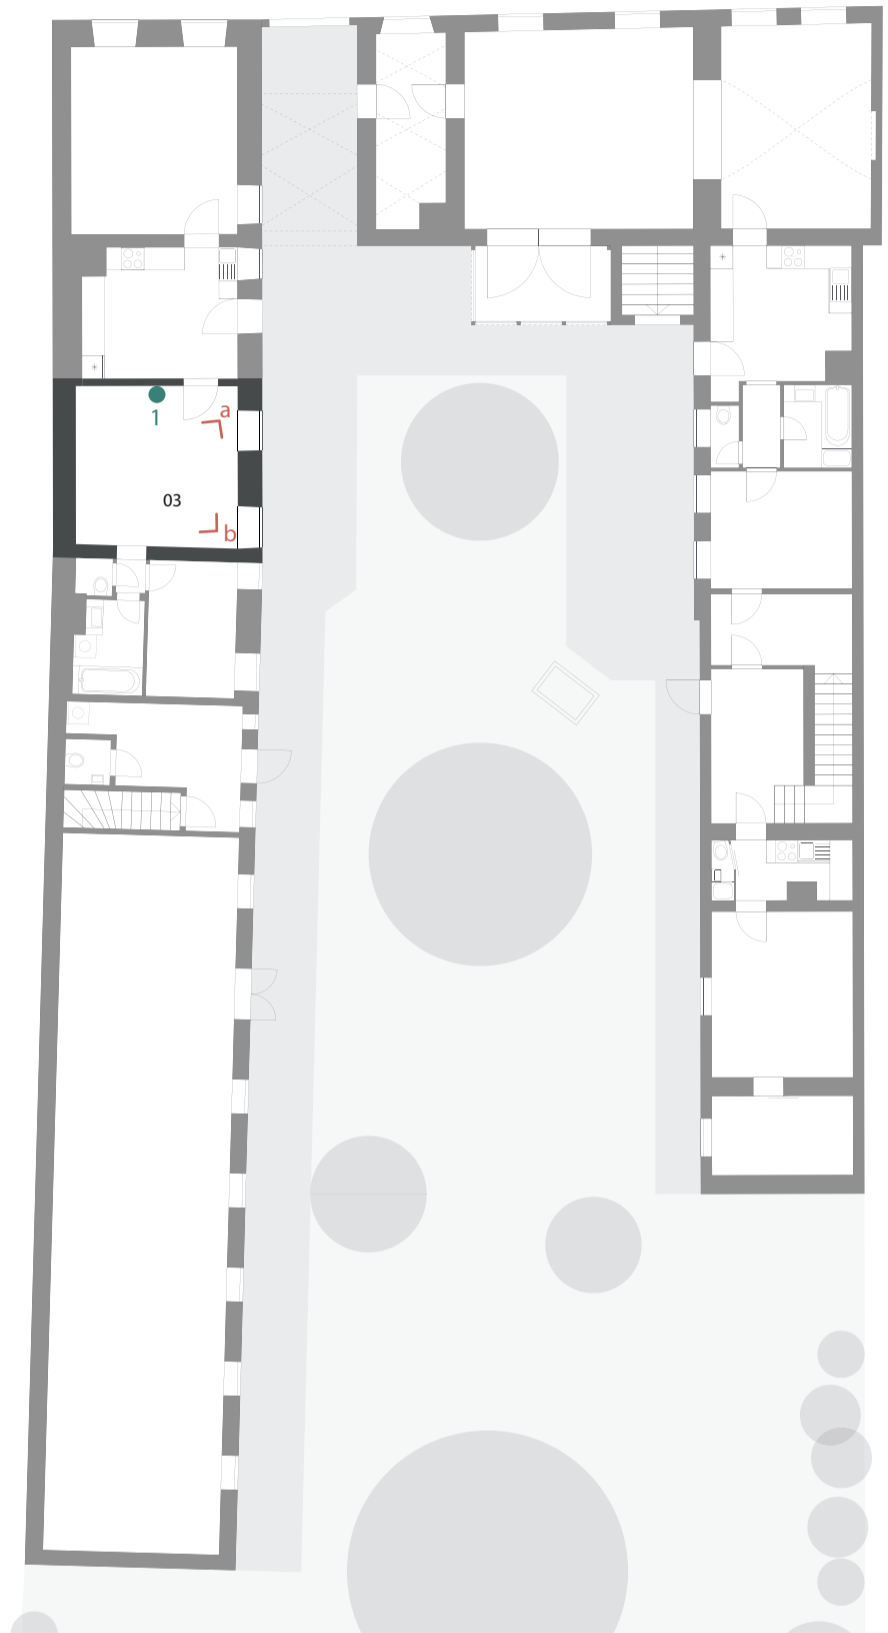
Grundriss Erdgeschoß | M 1:200 | Raum 03
